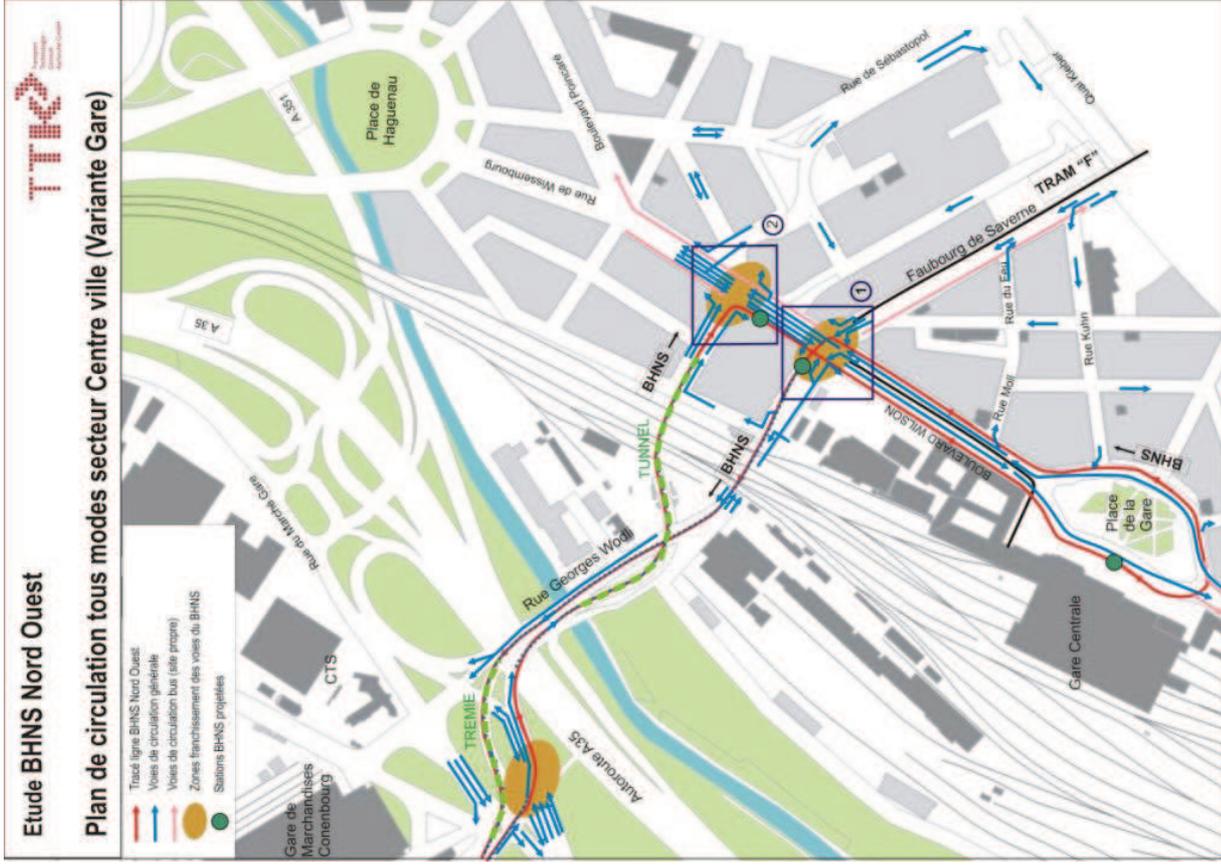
Plan de circulation bus et voiture secteur Gare centrale (BHNS)
